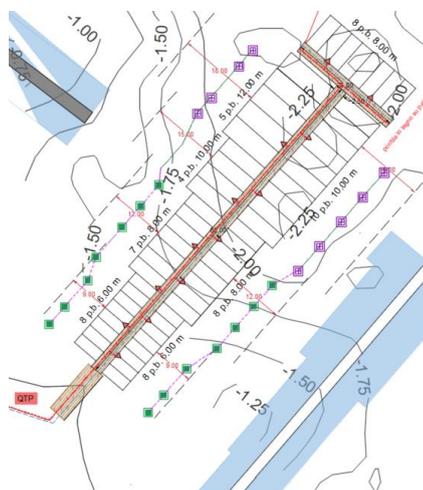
Stralcio planimetrico nuovo pontile in legno per l'ormeggio;
